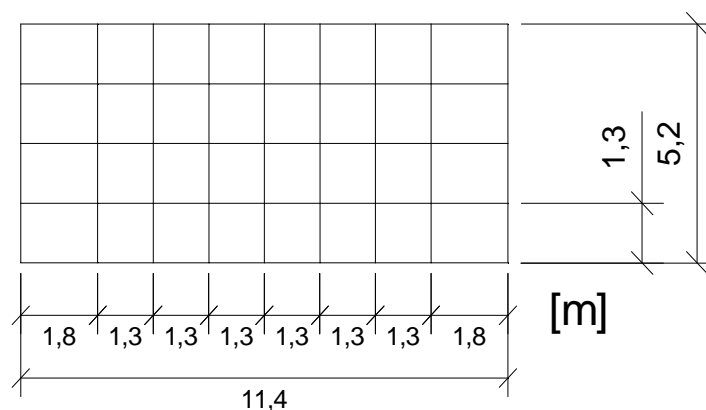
Vista Em Planta da Configuração do Cembre ao Solo Contínuo Adoptada Para Uma Secção Tipo de Um Viaduto com 20 m de Vão
